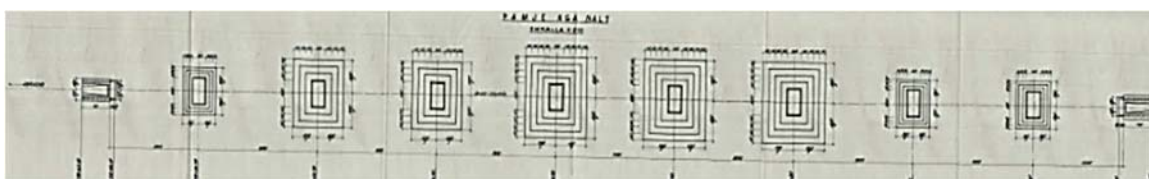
Planimetria. Prerje horizontale në risegën e plintave ([6])
